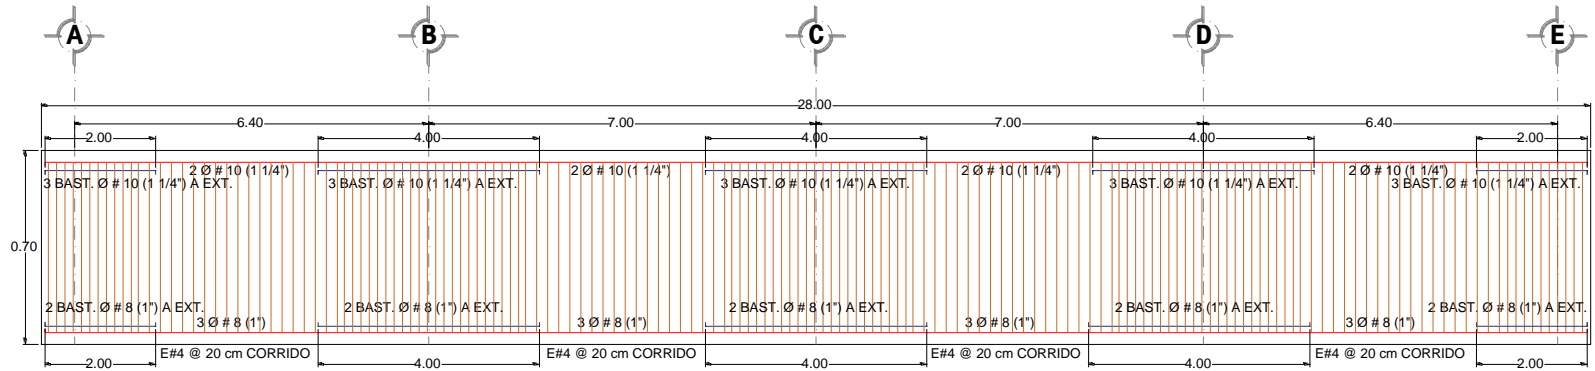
Detallado de armado de vigas y columnas del marco de 6 niveles con base a la hipótesis de las NTCC-17.
